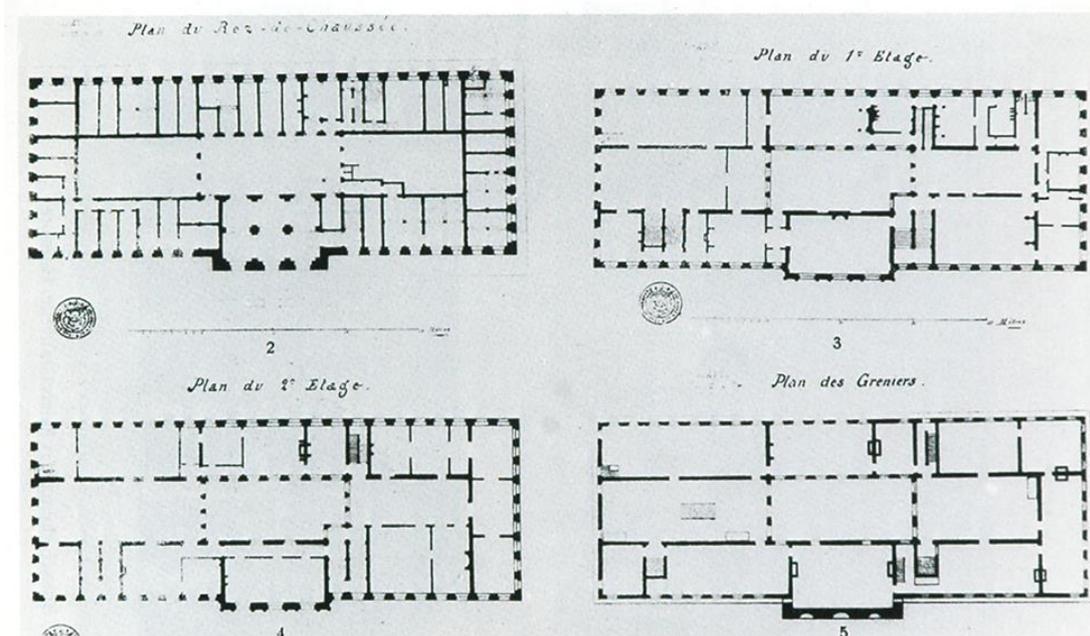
Antwerpen, Rathaus, Grundrisse des Zustandes vor den Veränderungen im 19. Jahrhundert (aus: Bevers 1985)
